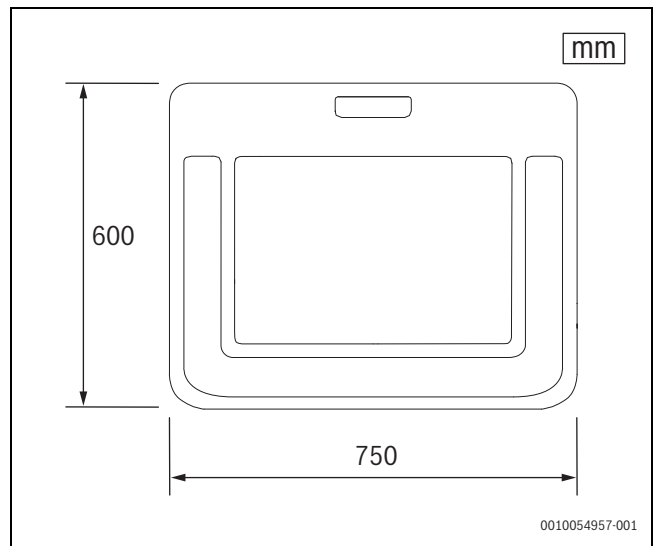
Dimensions des pièces latérales de la fondation préfabriquée
